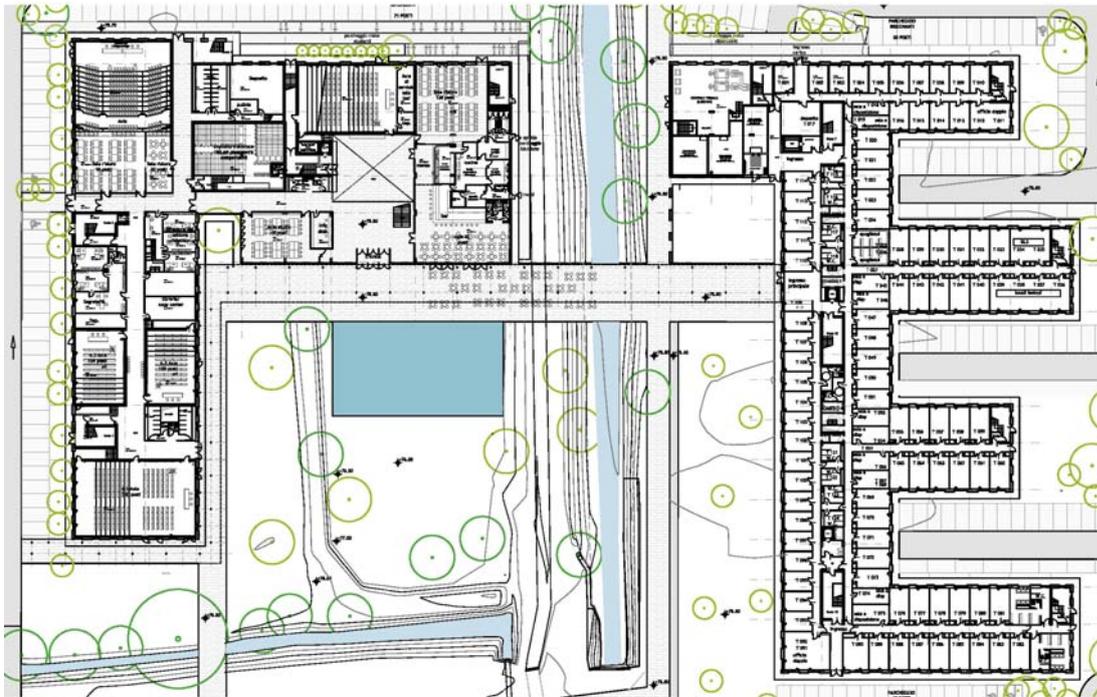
Pianta piano terra Lotto 1-2 e identificazione funzionale
